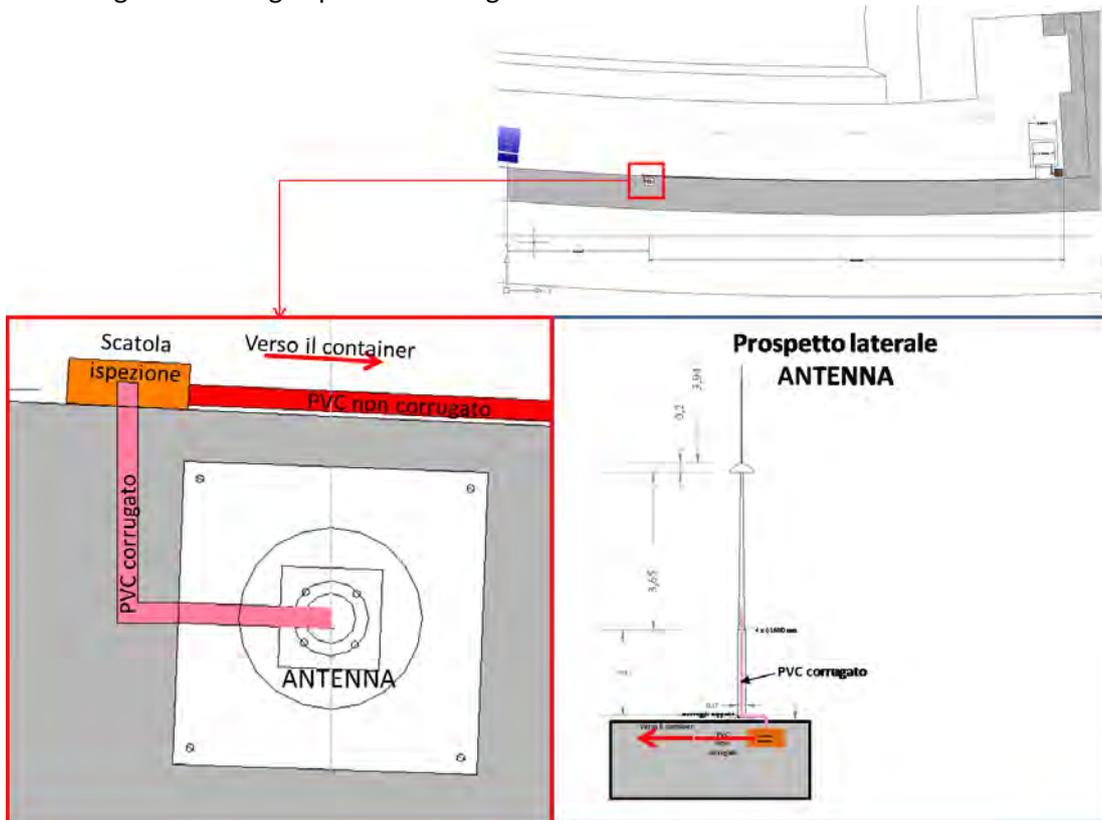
Dettaglio possibile collegamento dati al sito di installazione dell'antenna HF.
